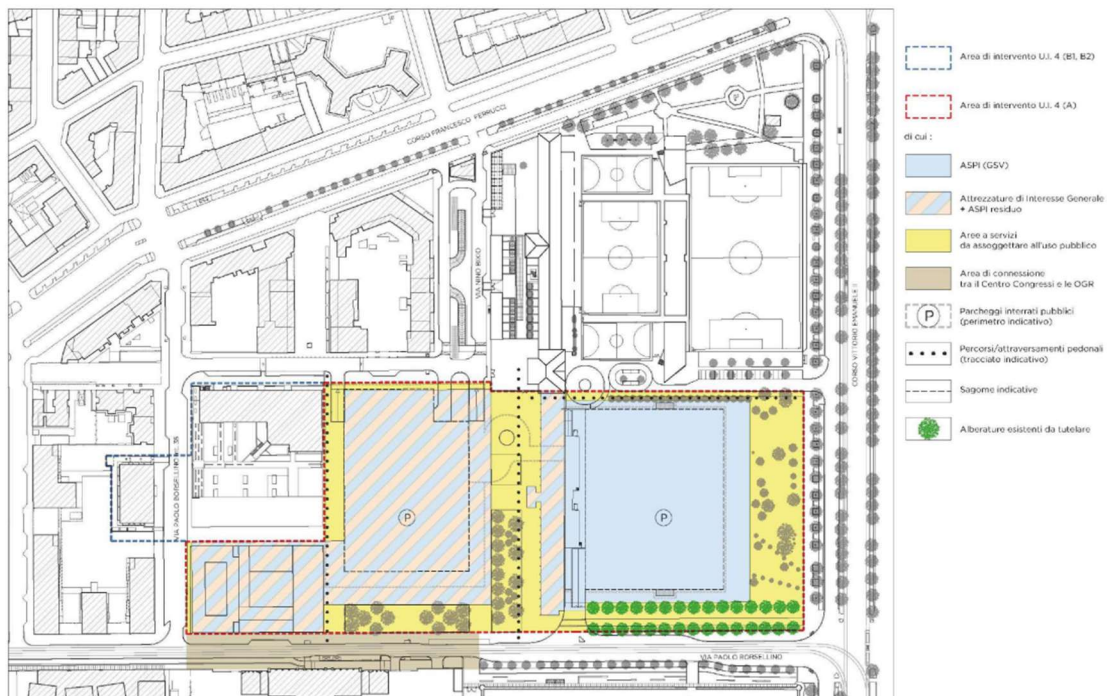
Destinazioni d'uso in progetto e individuazione unità di intervento.
